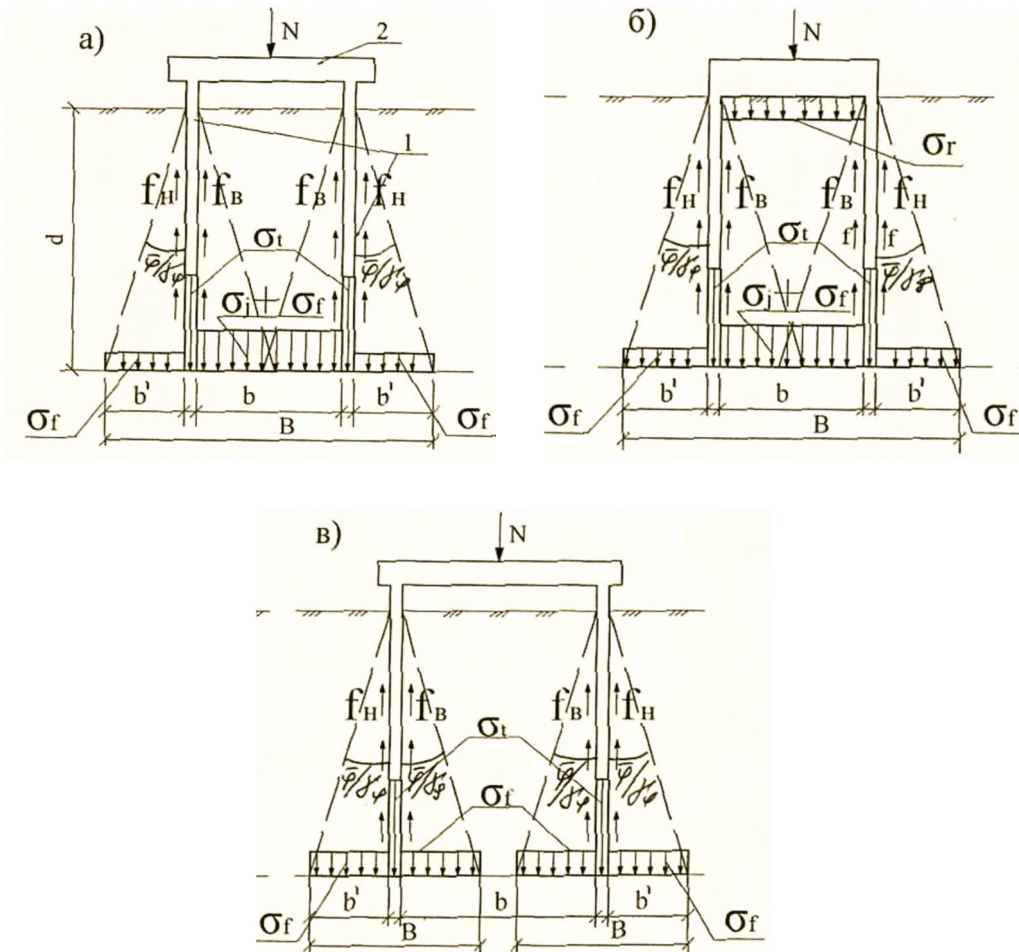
Розрахункові схеми взаємодії двошлієних стрічкових фундаментів з основою: а) двошарова основа фундаментів з високим ростверком; б) двошарова основа фундаментів з низьким ростверком; в) одношарова основа фундаментів з високим ростверком
